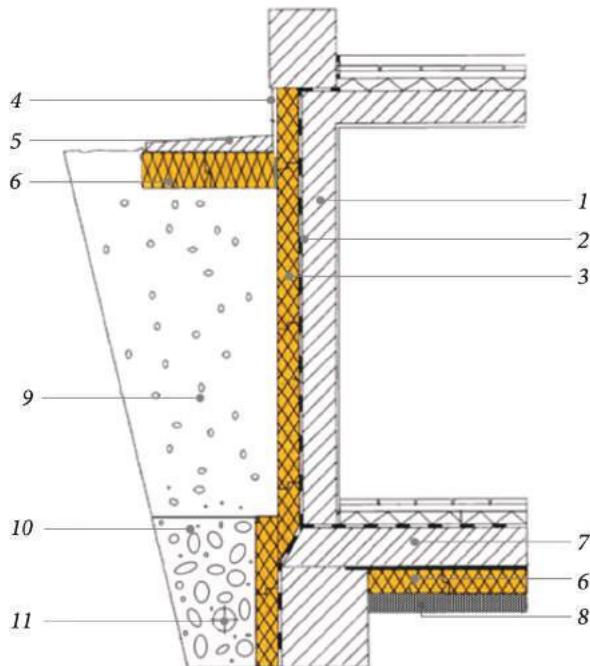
Устройство наружной теплоизоляции стены подземного сооружения: 1 — стена подземного сооружения; 2 — гидроизоляция; 3 — вертикальная теплоизоляция; 4 — цоколь; 5 — отмостка; 6 — горизонтальная теплоизоляция; 7 — бетонное основание; 8 — гравийное основание; 9 — дренирующий грунт; 10 — дренажная обсыпка; 11 — дренажная труба
